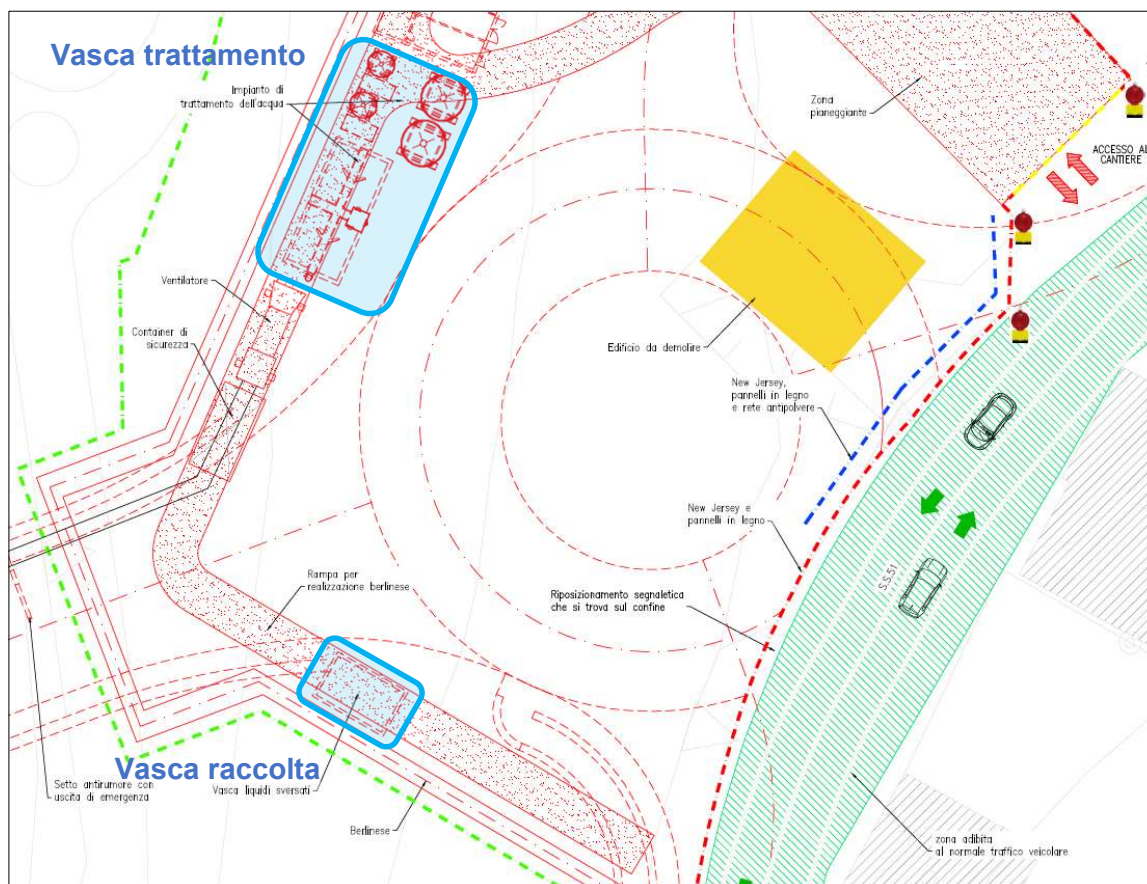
Layout cantiere 1 – vasca trattamento e vasca raccolta.
